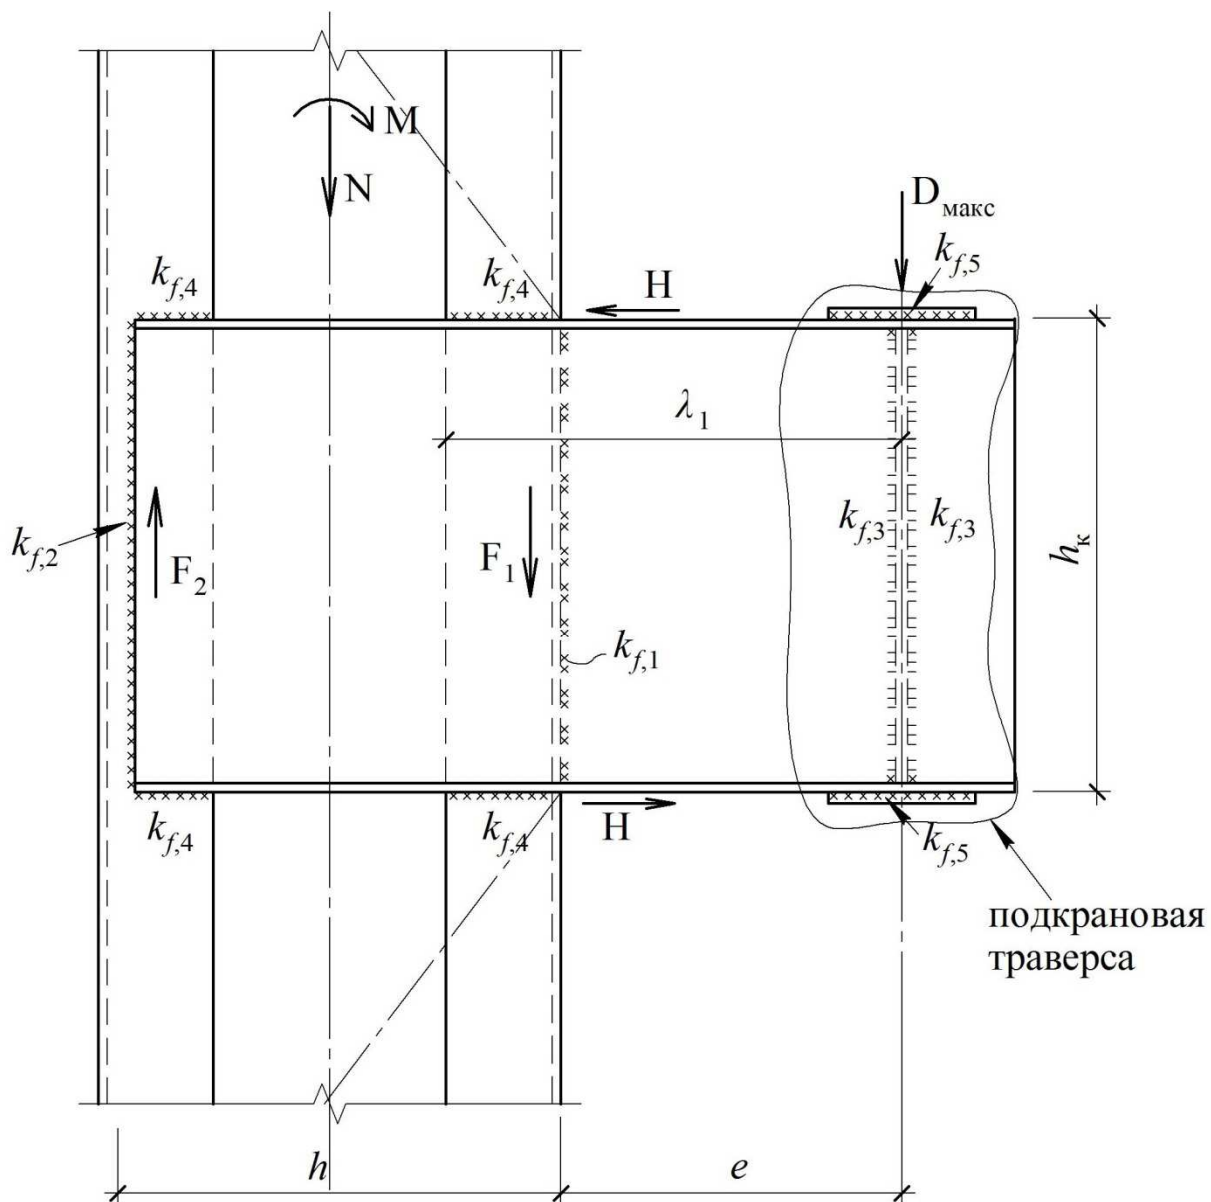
Конструктивная схема двухстенчатой консоли
